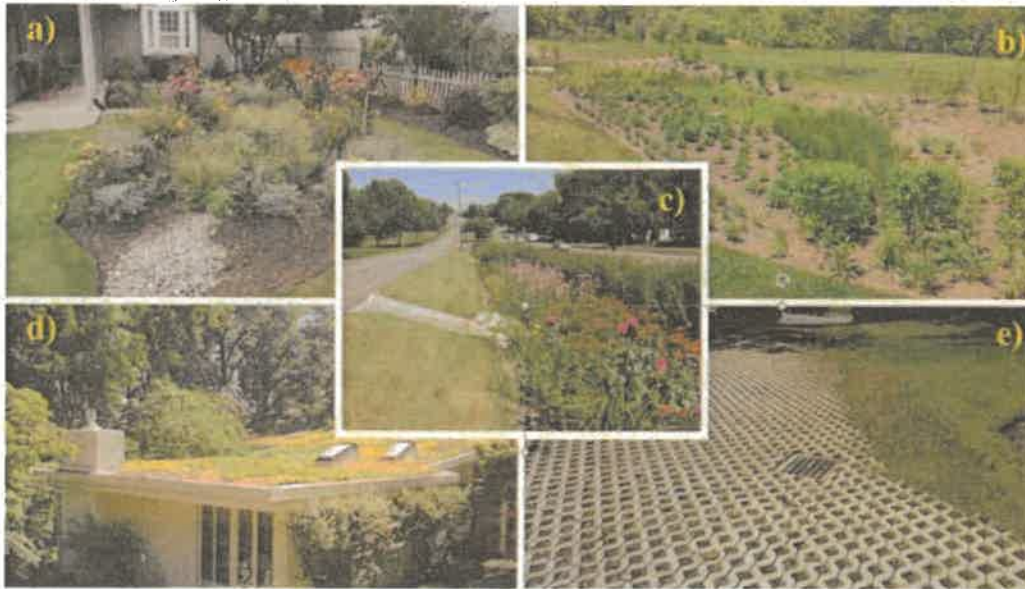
Prácticas de desarrollo de bajo impacto (LID): a) Jardín pluvial; b) Estanque de biorretención; c) Zanja vegetada; d) Techo verde; e) Pavimento permeable.
